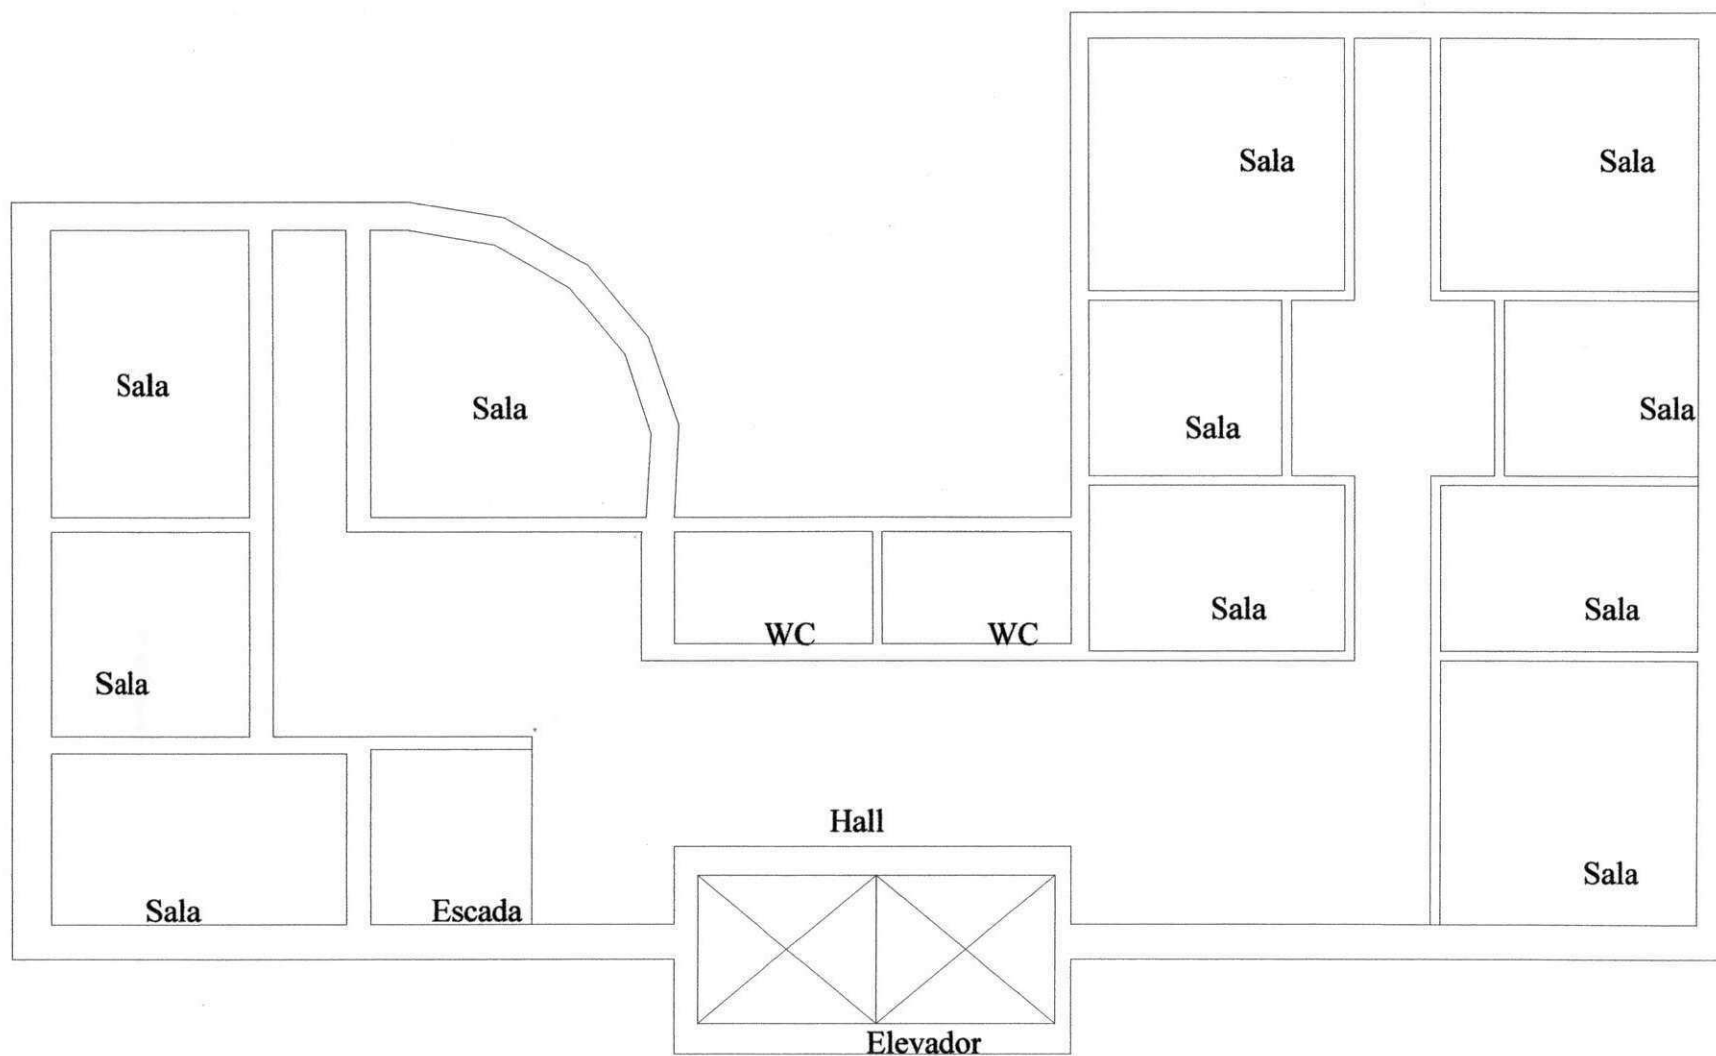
Esboço da Planta baixa do pavimento tipo do edifício
